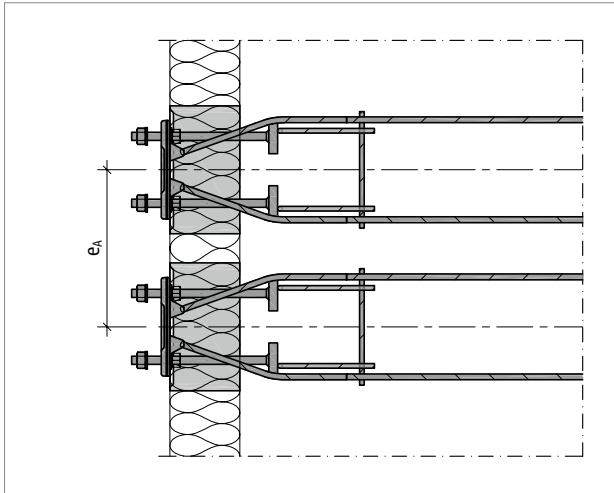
Schöck Isokorb® XT Typ SQP: Achsabstand
